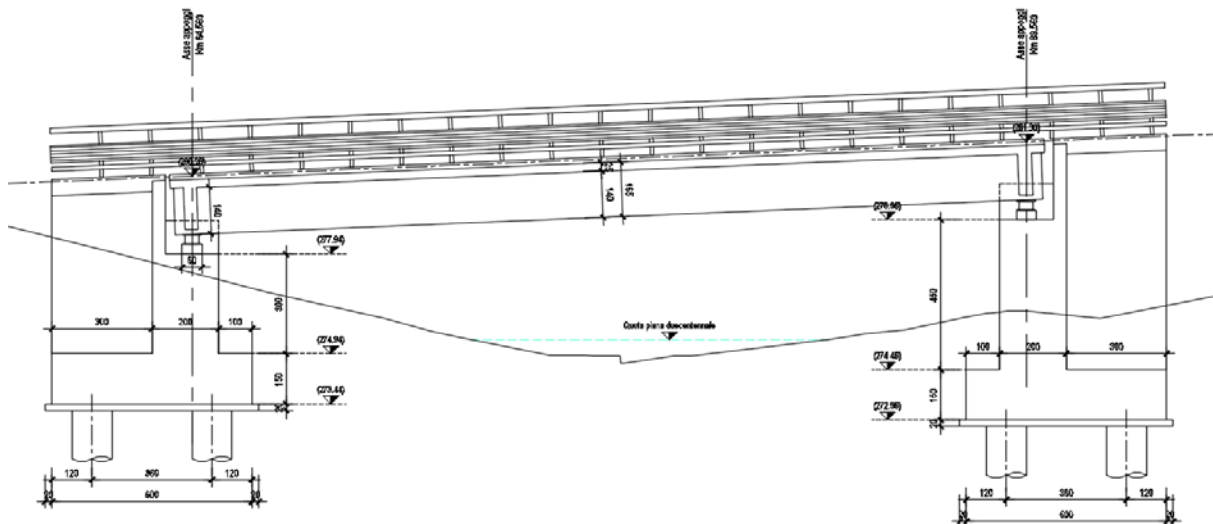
Sezione longitudinale del Ponte inizio lotto.
